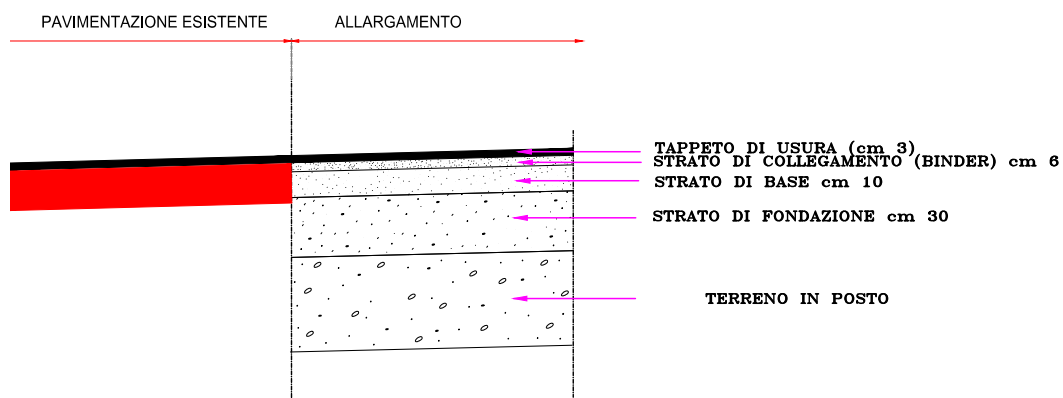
Particolare pavimentazione nei tratti in allargamento
